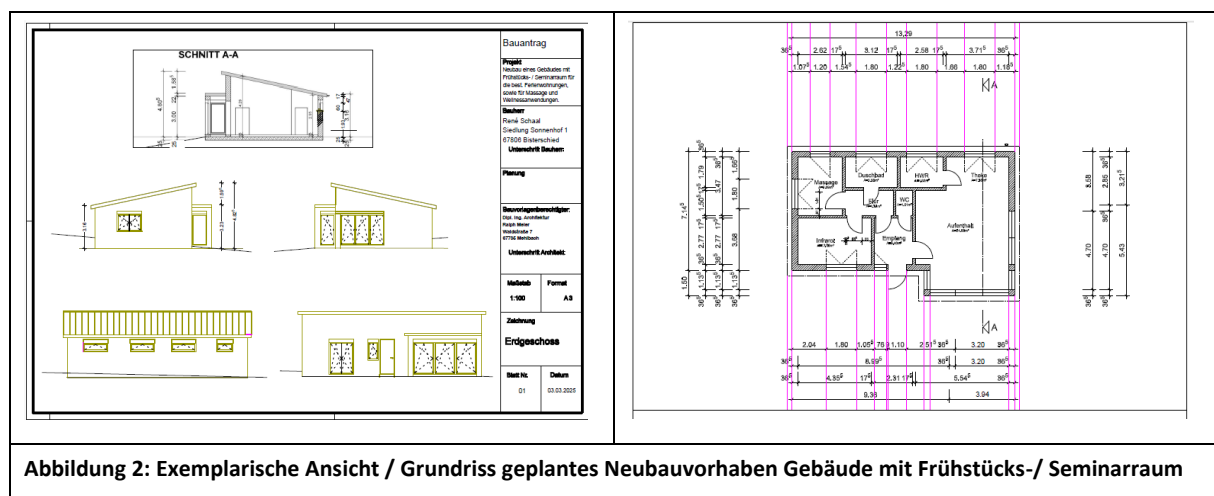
Exemplarische Ansicht / Grundriss geplantes Neubauvorhaben Gebäude mit Frühstücks-/ Seminarraum
